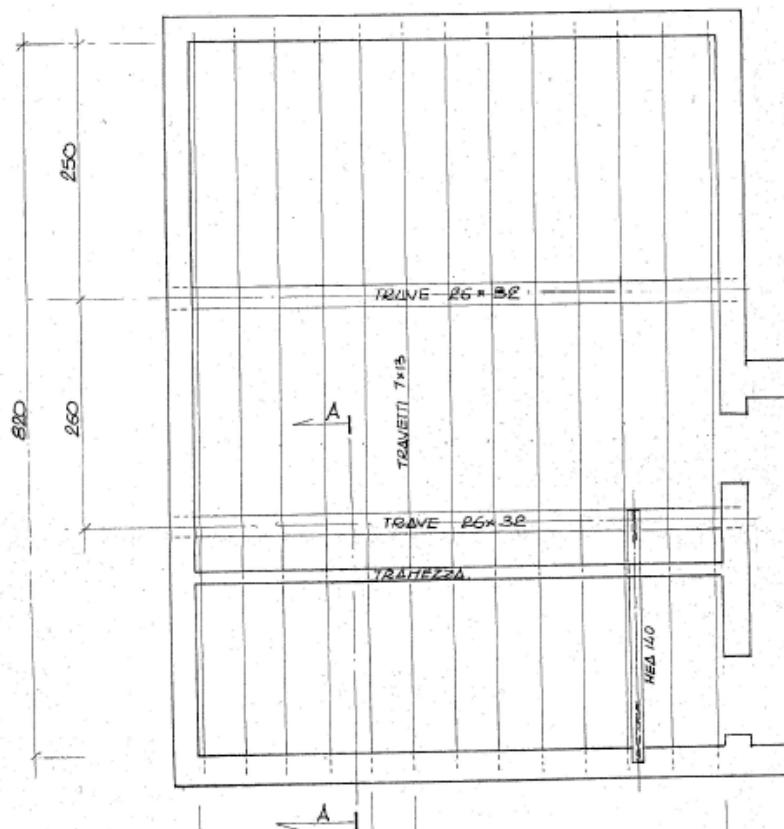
Torre: pianta 2° piano - intervento di consolidamento (Mezzadri, 1970)
